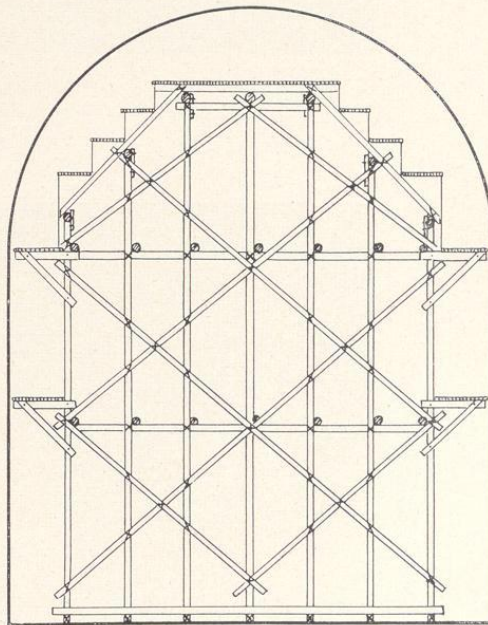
Stufengerüst aus Stangen für eine Halle mit Halbkreisgewölbe
